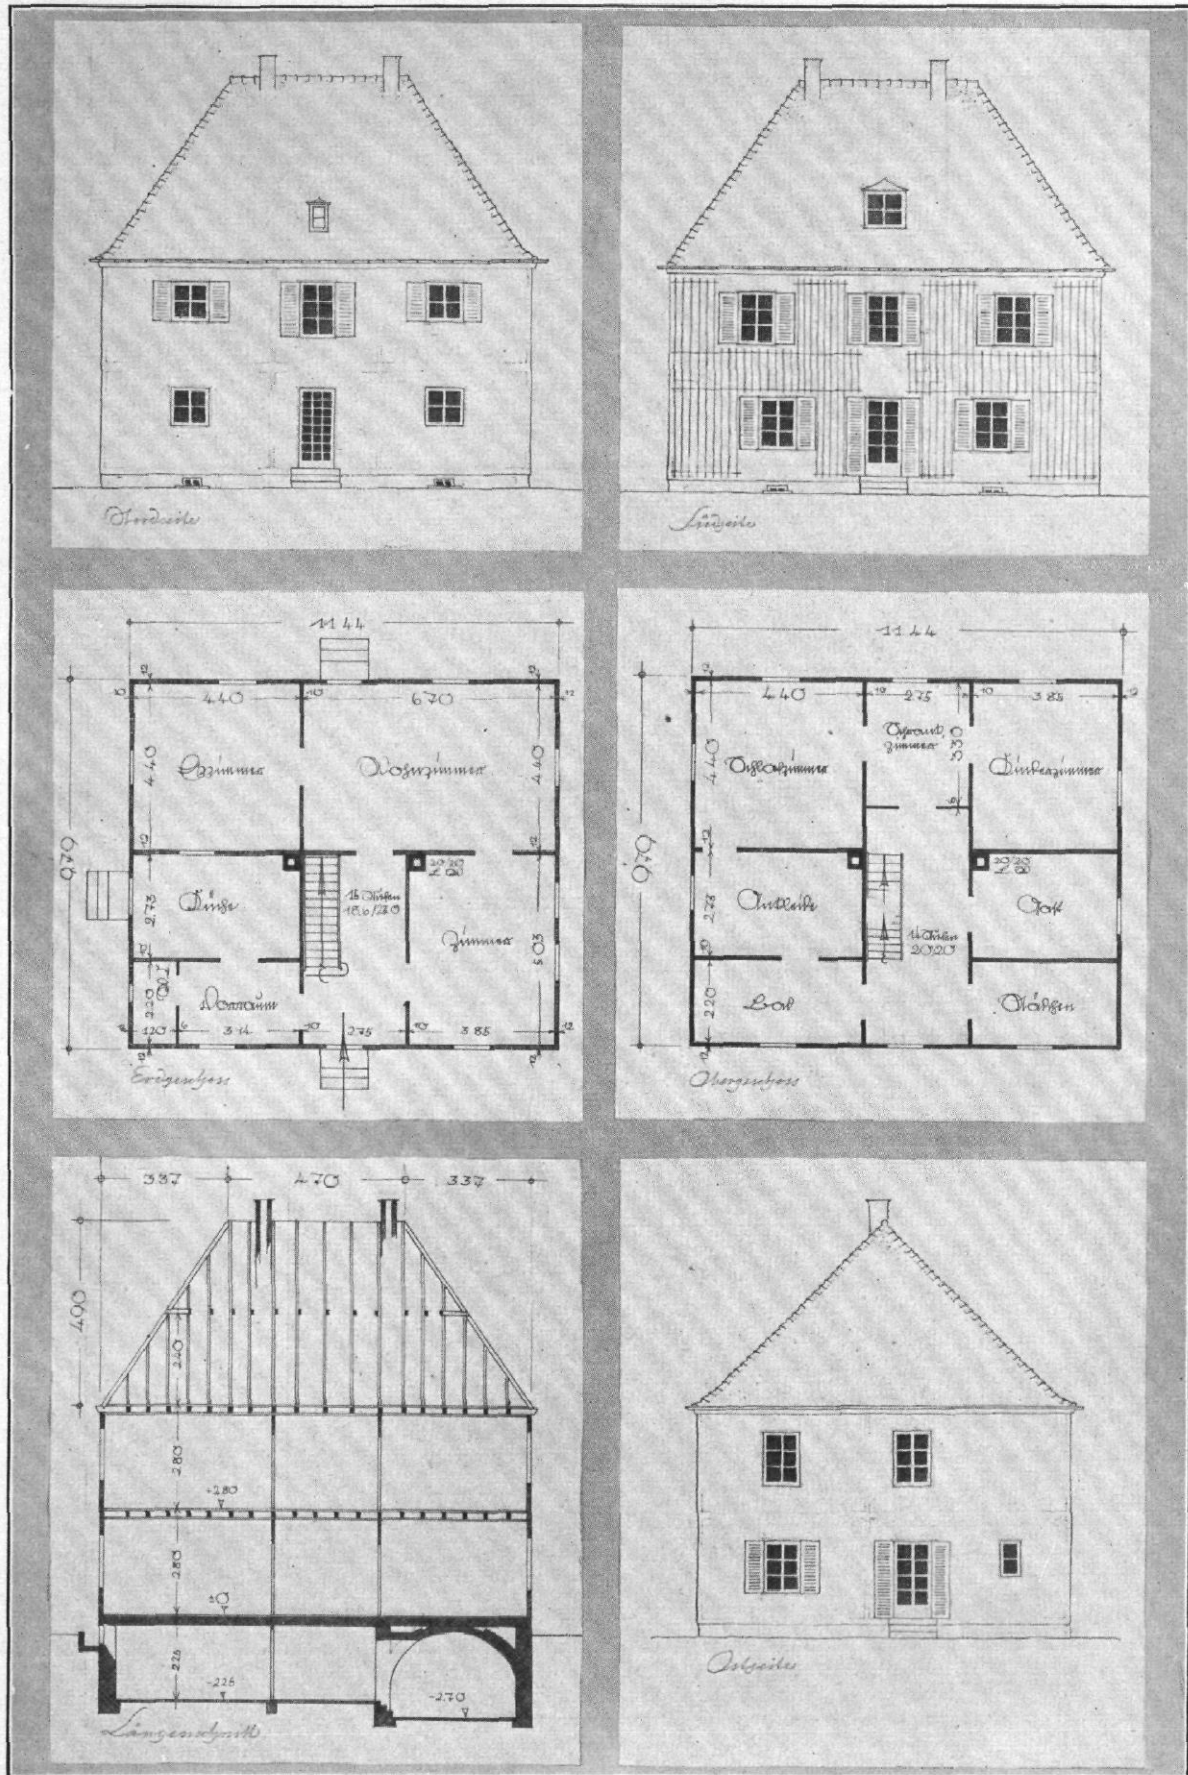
| Fabriziertes Fachwerkhans, Hanstyp F, auf ebenem Gelände | Architekt: Paul Schmittbener, Stuttgart
